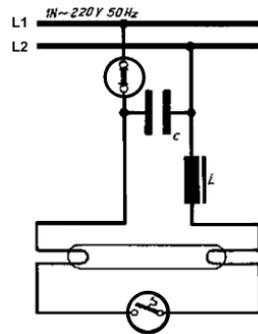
Lampu tabung fasa tunggal kutub tunggal
